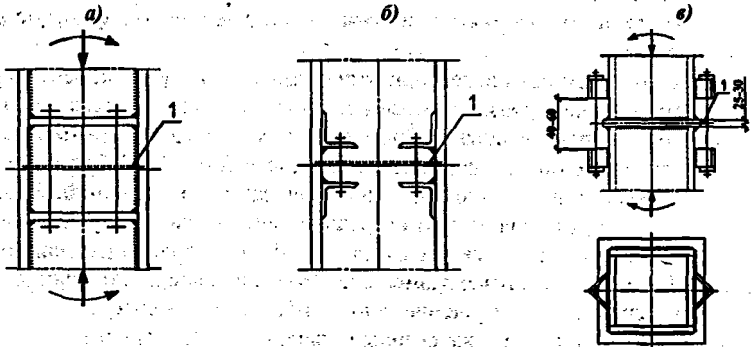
Сварные стыки колонн при больших эксцентриситетах:
